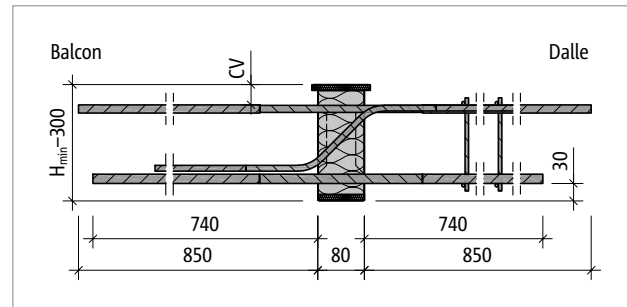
Schöck Isokorb® T Type K-M13 à M14-V1 : Coupe du produit
